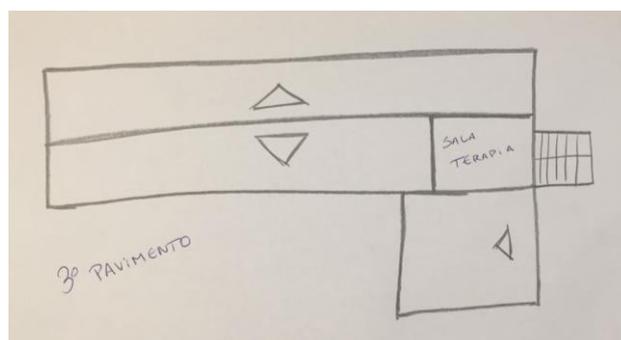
Croqui esquemático da planta baixa do 3º pavimento do Santé Spa.
